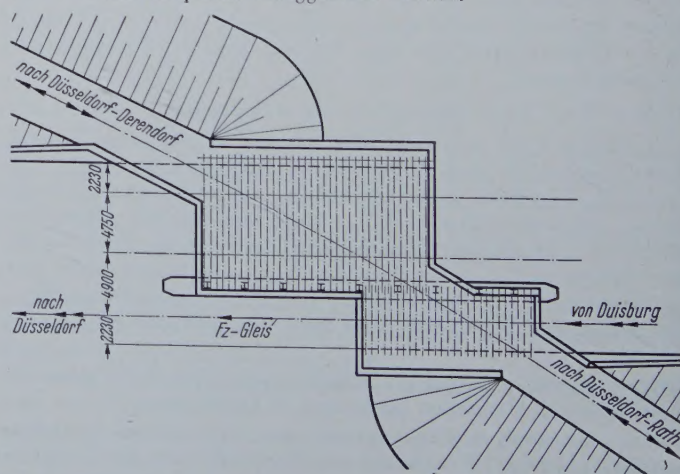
Grundriß des früheren, zerstörten Kreuzungsbauwerkes
